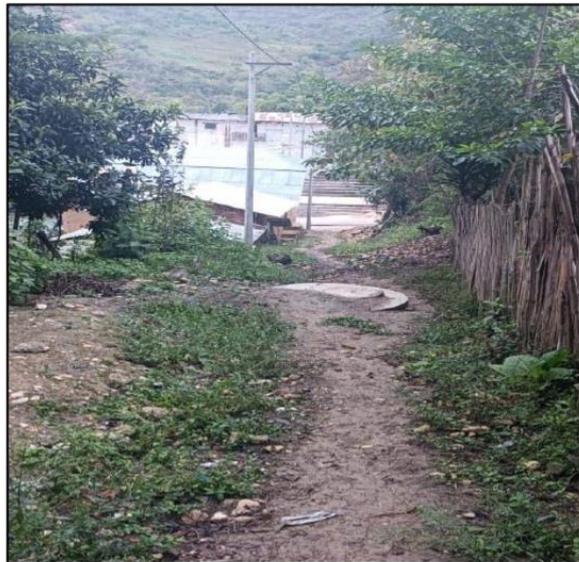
Cuadra 01 de la calle Vilchez Murga, será intervenida por el proyecto, cuenta con agua y alcantarillado actualmente, se encuentra en pésimo estado de transitabilidad.
